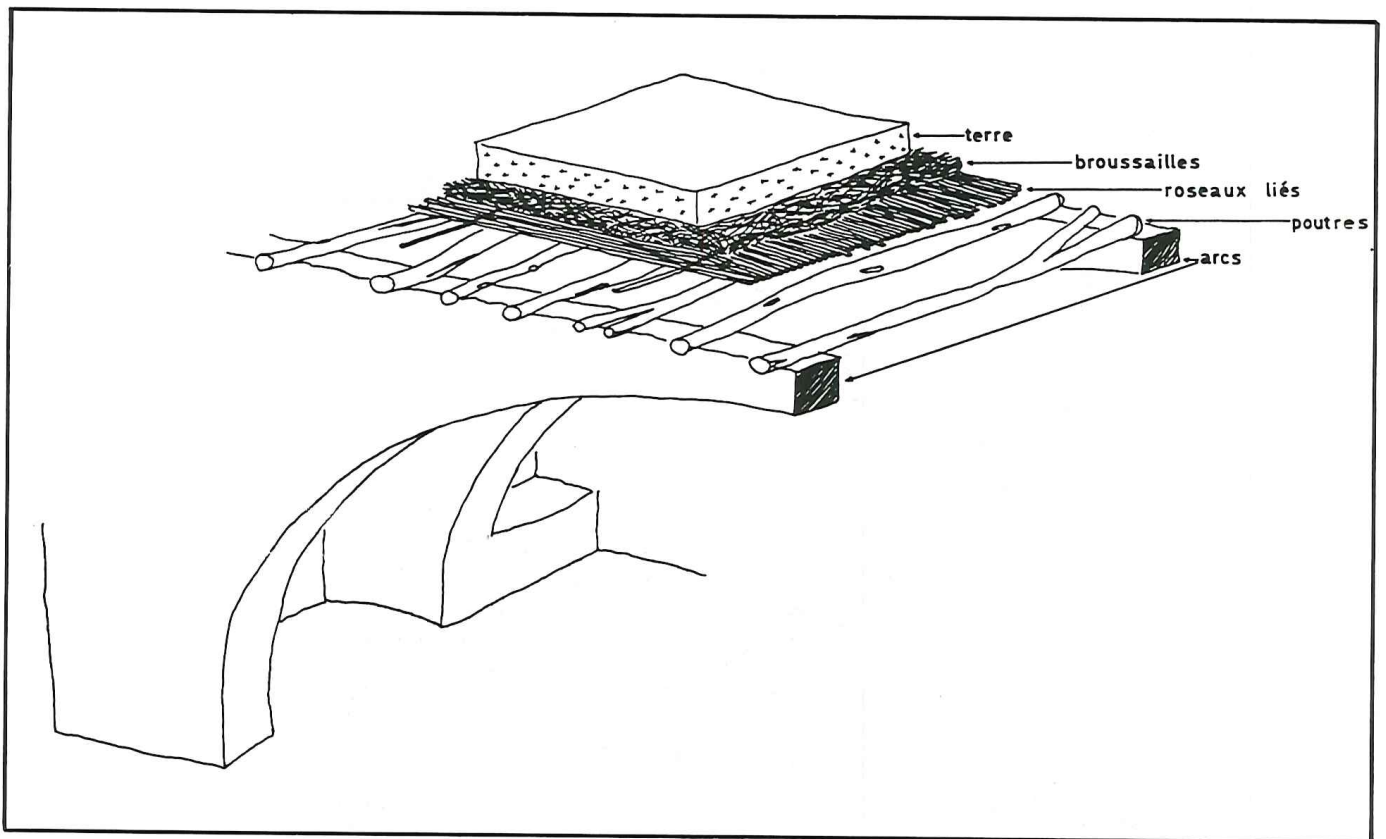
Coupe à travers une toiture traditionnelle. Dessin M. Denès.
